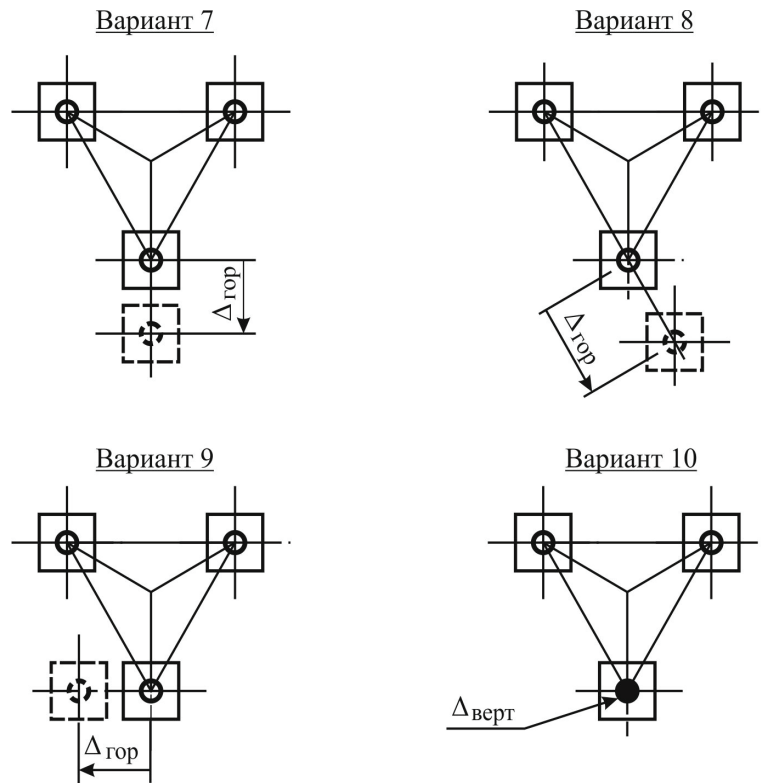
Варианты смещения фундаментов для трехгранных башен.
